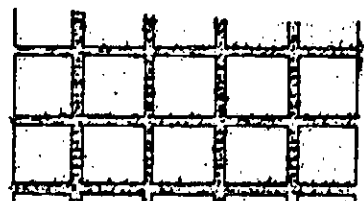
DALISAS DE PIEDRA CON JUNTA
